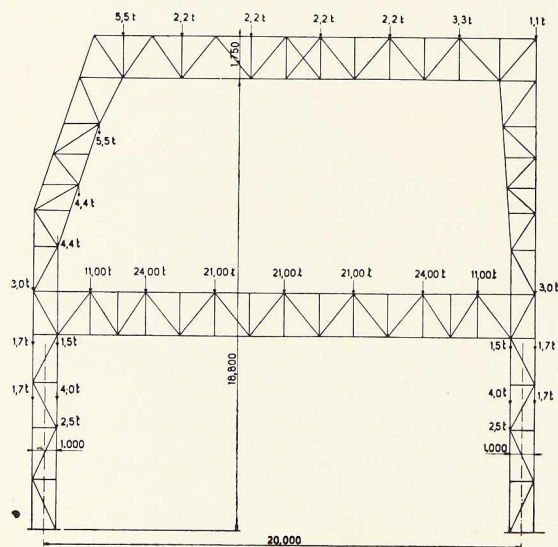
Elévation d'un portique en treillis. Les membrures sont en poutrelles HN 200, les diagonales et les montants sont en poutrelles AP 200.
